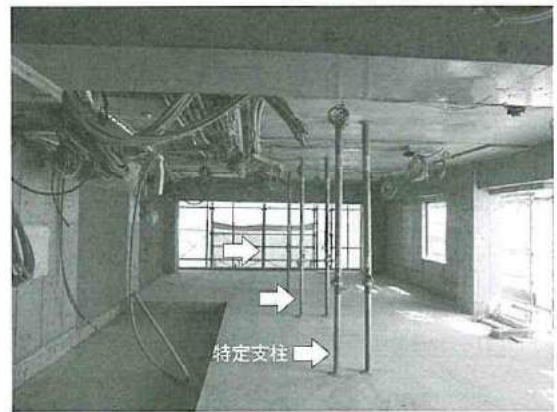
N-1階施工状況① [壁左官補修, 天井配管]
